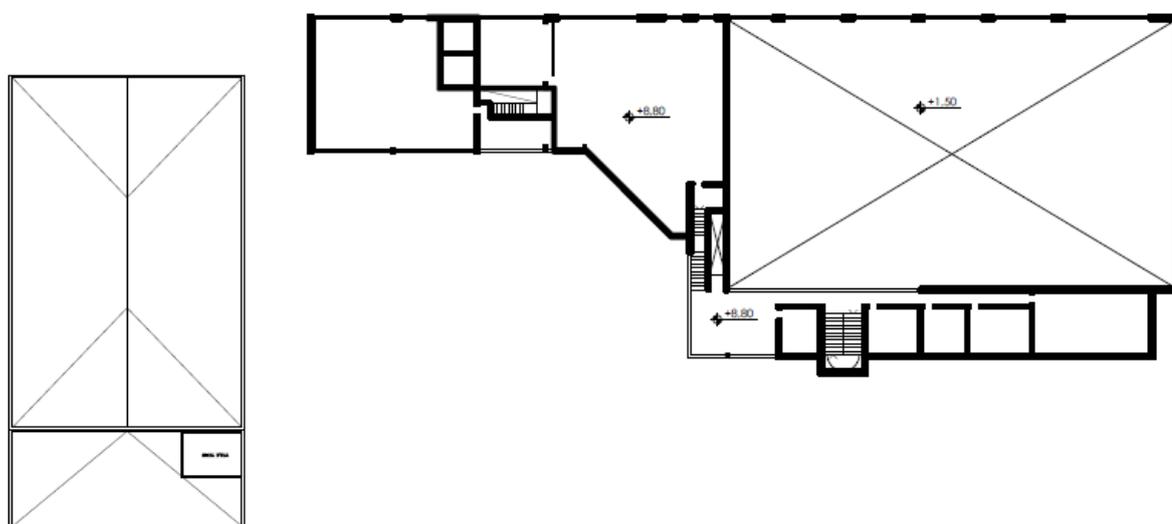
Planta Baixa Antiga - 2º PAVIMENTO. Fonte: produzido pela Autora.
